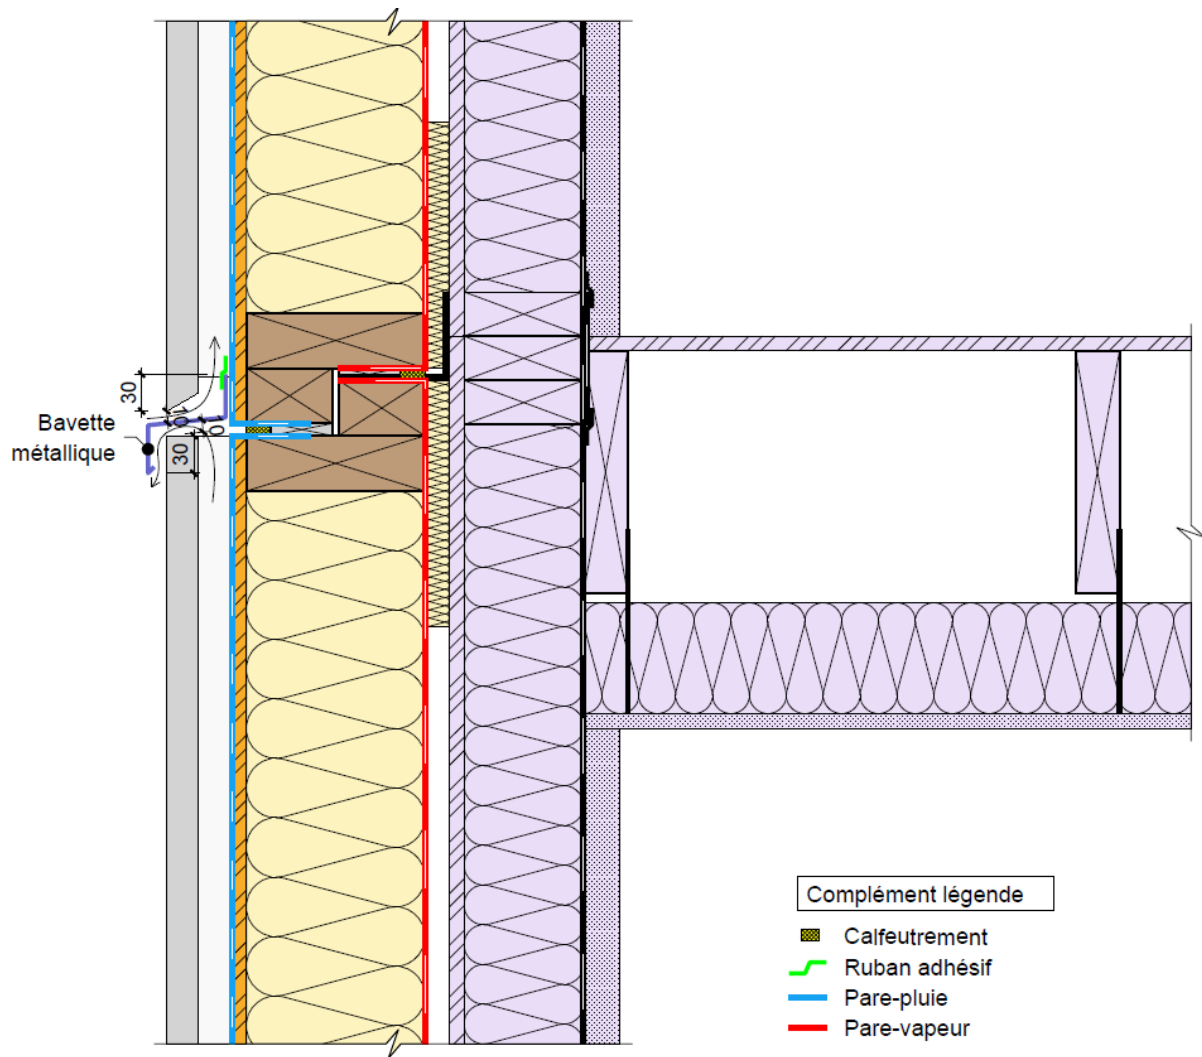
Plancher intermédiaire – avec recoupement de lame d’air du bardage (coupe verticale)
